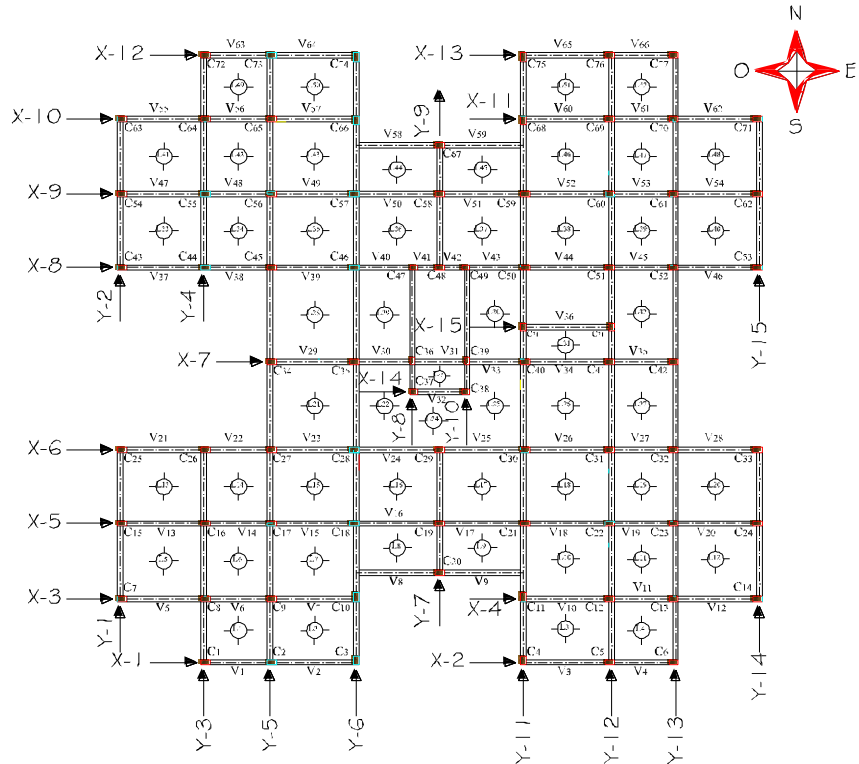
PLANTA ESTRUCTURAL TIPO (1º - 6º Piso)
